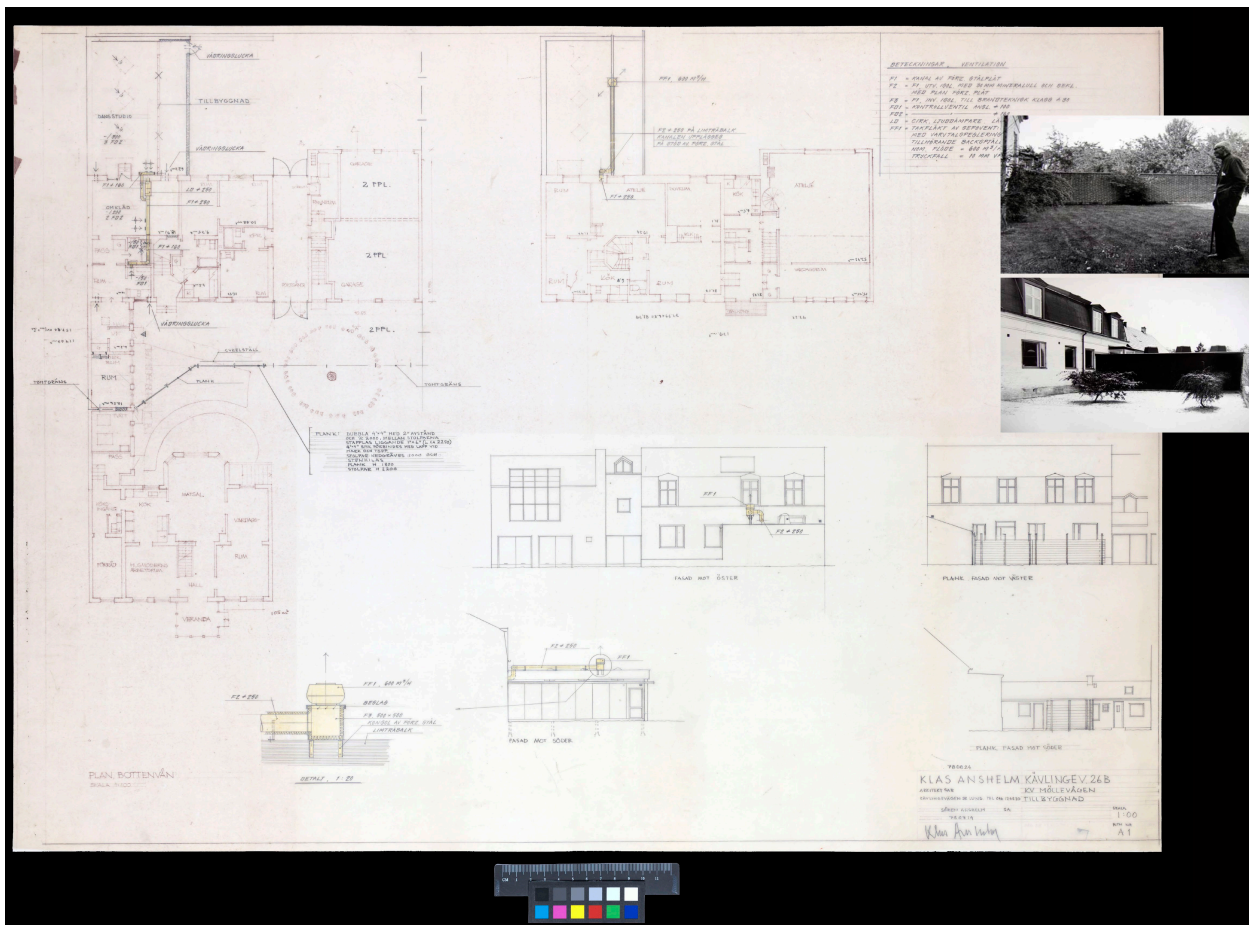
26 de Kavlingeavagen en Lund, 1970. Planta y sección longitudinal de la parcela.
